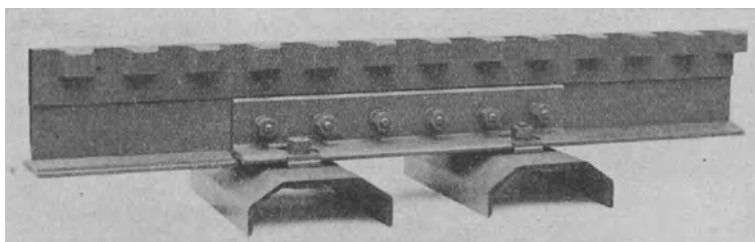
Kletterzahnstange Peter auf Eisenschwellen.
